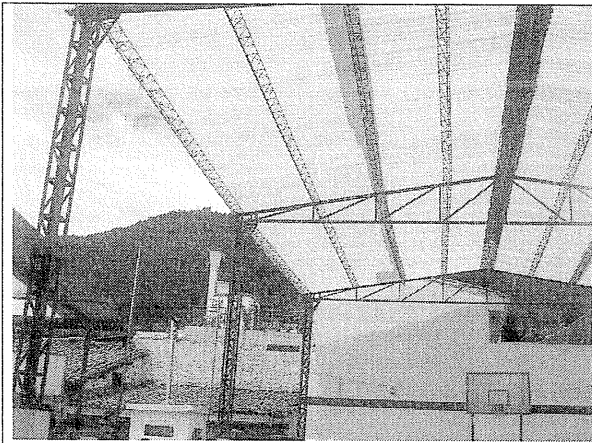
Estructura de cubierta de la parte posterior en buen estado.
